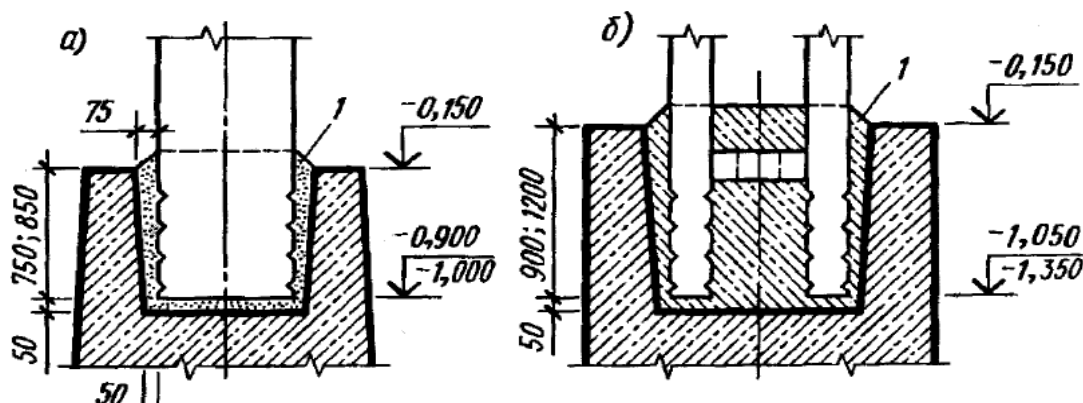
Стыки железобетонных колонн с фундаментами
